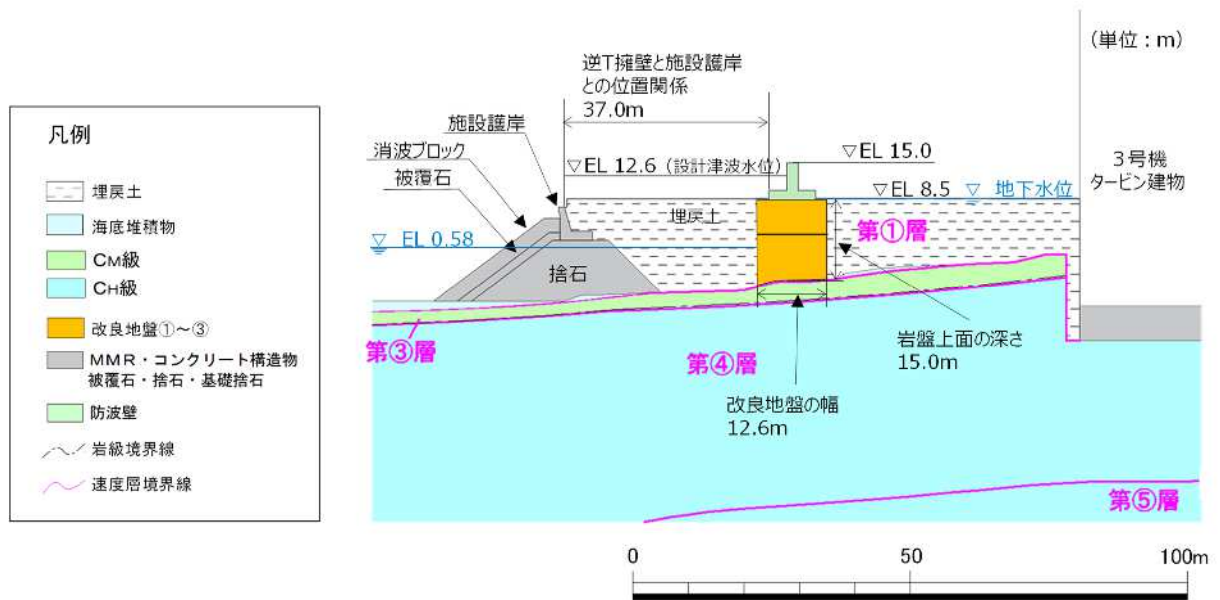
防波壁（逆T擁壁）の横断面図（④-④断面）
